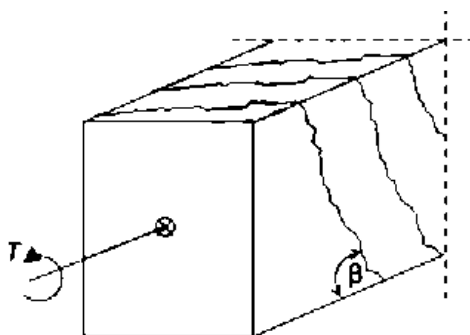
Fissuration d'une poutre soumise à un moment de torsion
